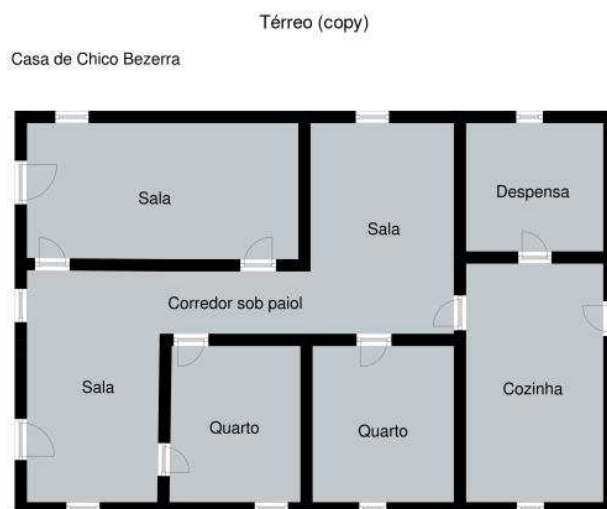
Reprodução da planta baixa atual da *Casa velha*. Construção do autor. Fonte: Floorplanner.
